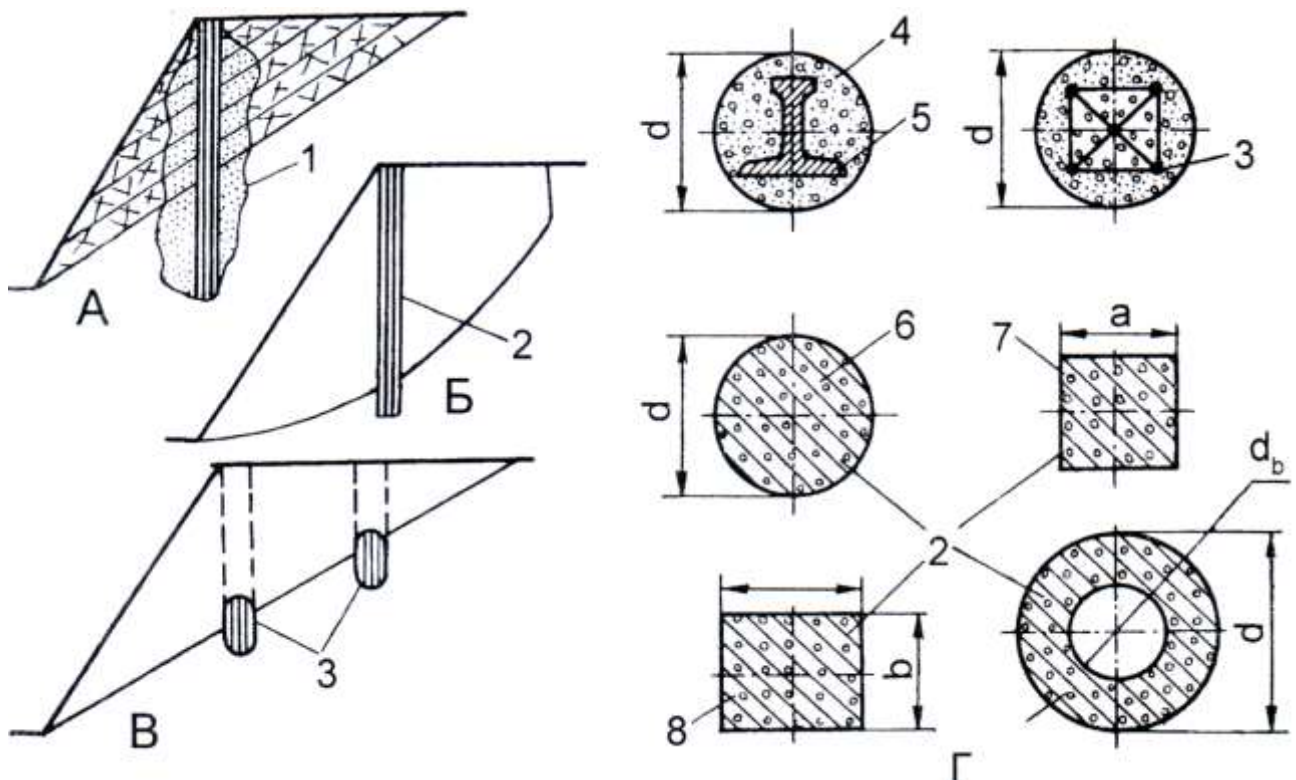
Схемы укрепления уступов железобетонными сваями и шпонами: А – железобетонная свая с цементацией массива; Б – трубчатая свая большого диаметра; В – железобетонные шпоны; Г – сечения железобетонных свай: 1 – свая набивного типа; 2 – свая заводского изготовления; 3 – гибкая арматура; 4 – бетон; 5 – жёсткая арматура из рельса; 6 – свая круглого сечения; 7 – свая квадратного сечения, 8 – свая прямоугольного сечения; a , b – поперечные размеры свай квадратного и прямоугольного сечения; d , d_b – внешний и внутренний диаметры свай круглого и трубчатого сечения
